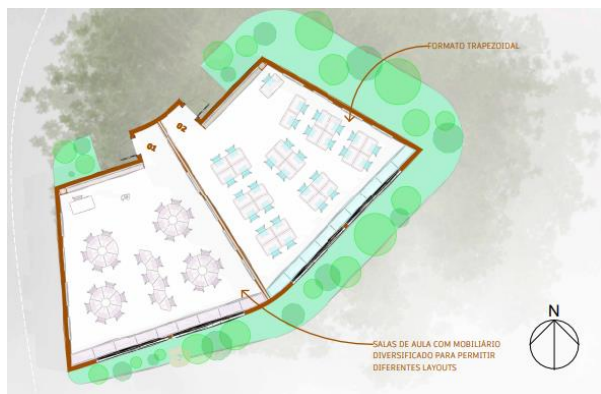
Planta Baixa da Sala de Aula 01 apresentando proposta de Layout e estudo de reflexão (Autores, 2023).
